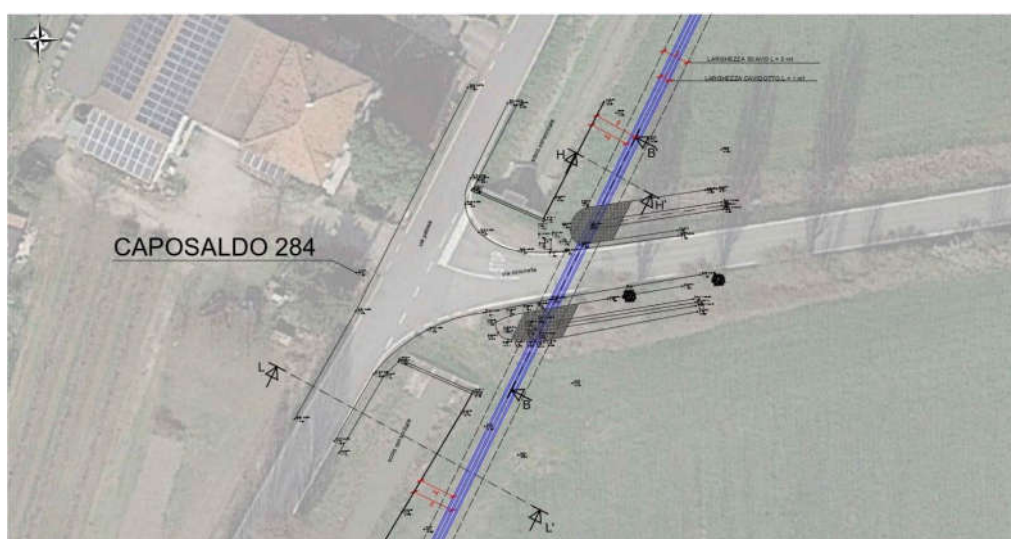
Tratto B-B' - Rilievo planoaltimetrico post-intervento
